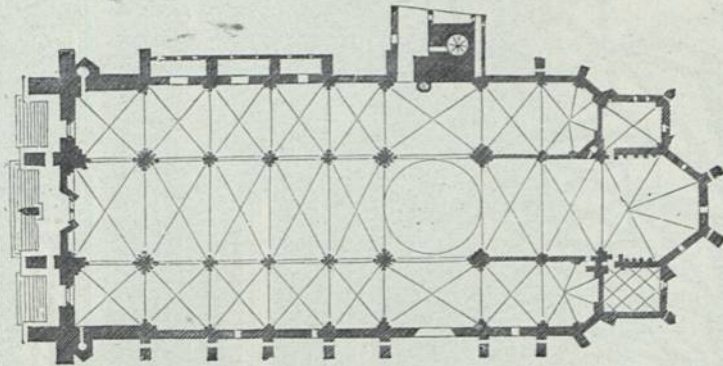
Grundriss einer Kirche mit deutschem Chorplan
